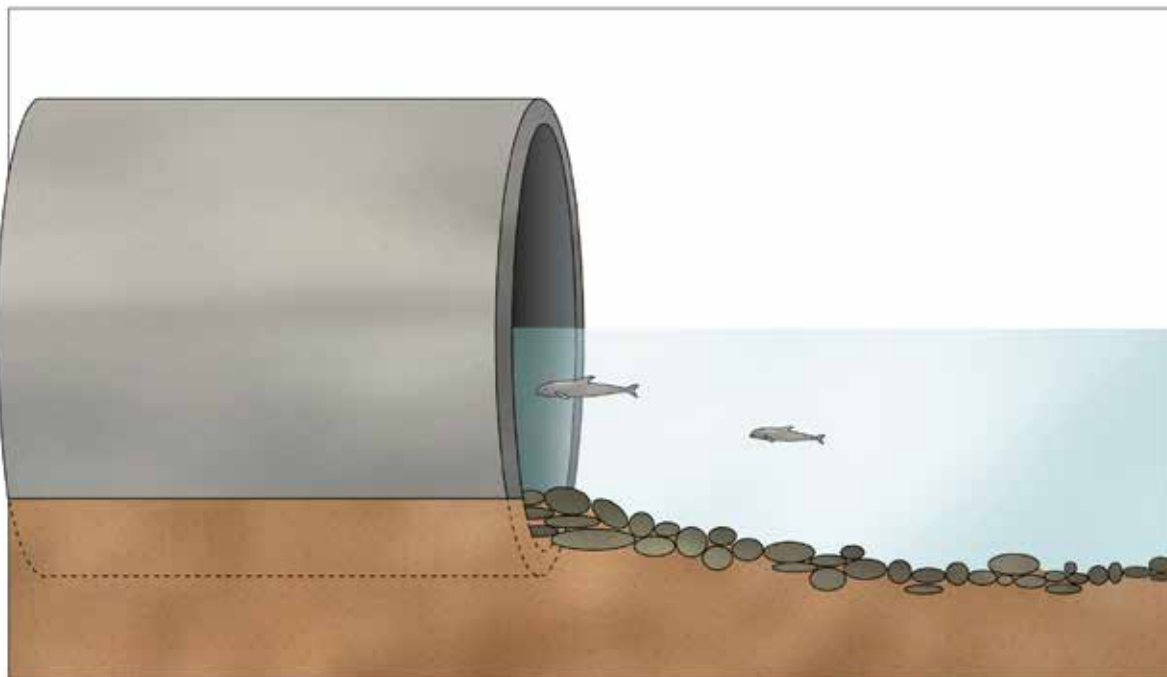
Adaptación de un drenaje para facilitar el paso de fauna.
